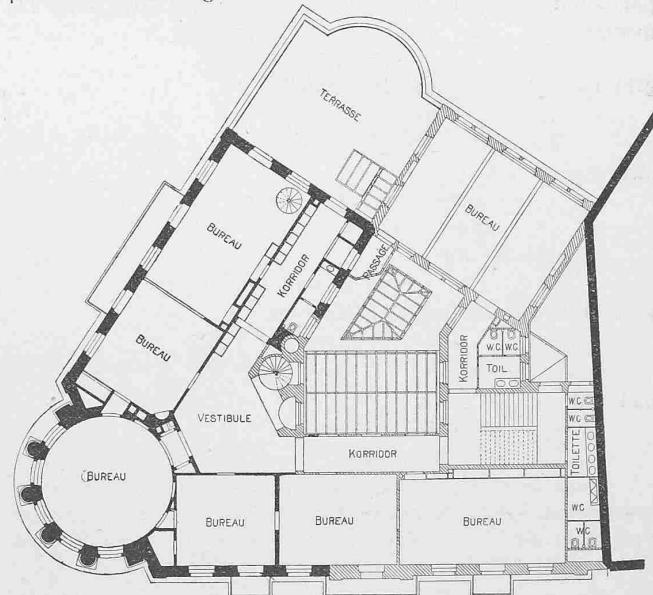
Handelsbank nach dem Umbau. Grundriss vom I. Stock.
